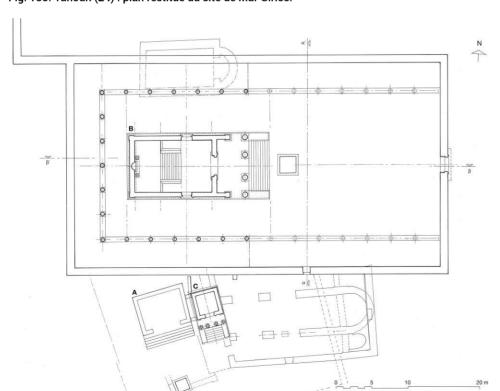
Yanouh (24) : plan restitué du site de Mar Girios.
